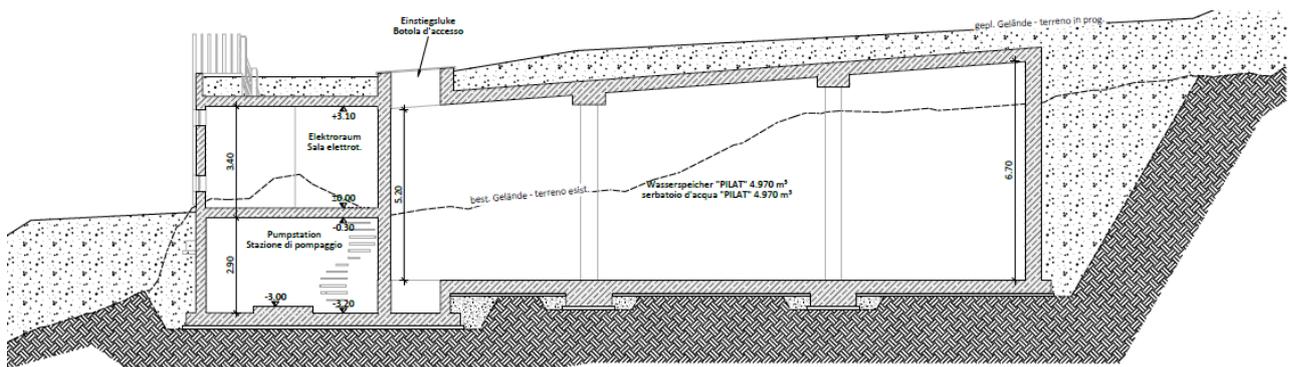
Auszug Projektplan Grundrisse und Schnitte BCG19-009_3.2-R1 [5]
